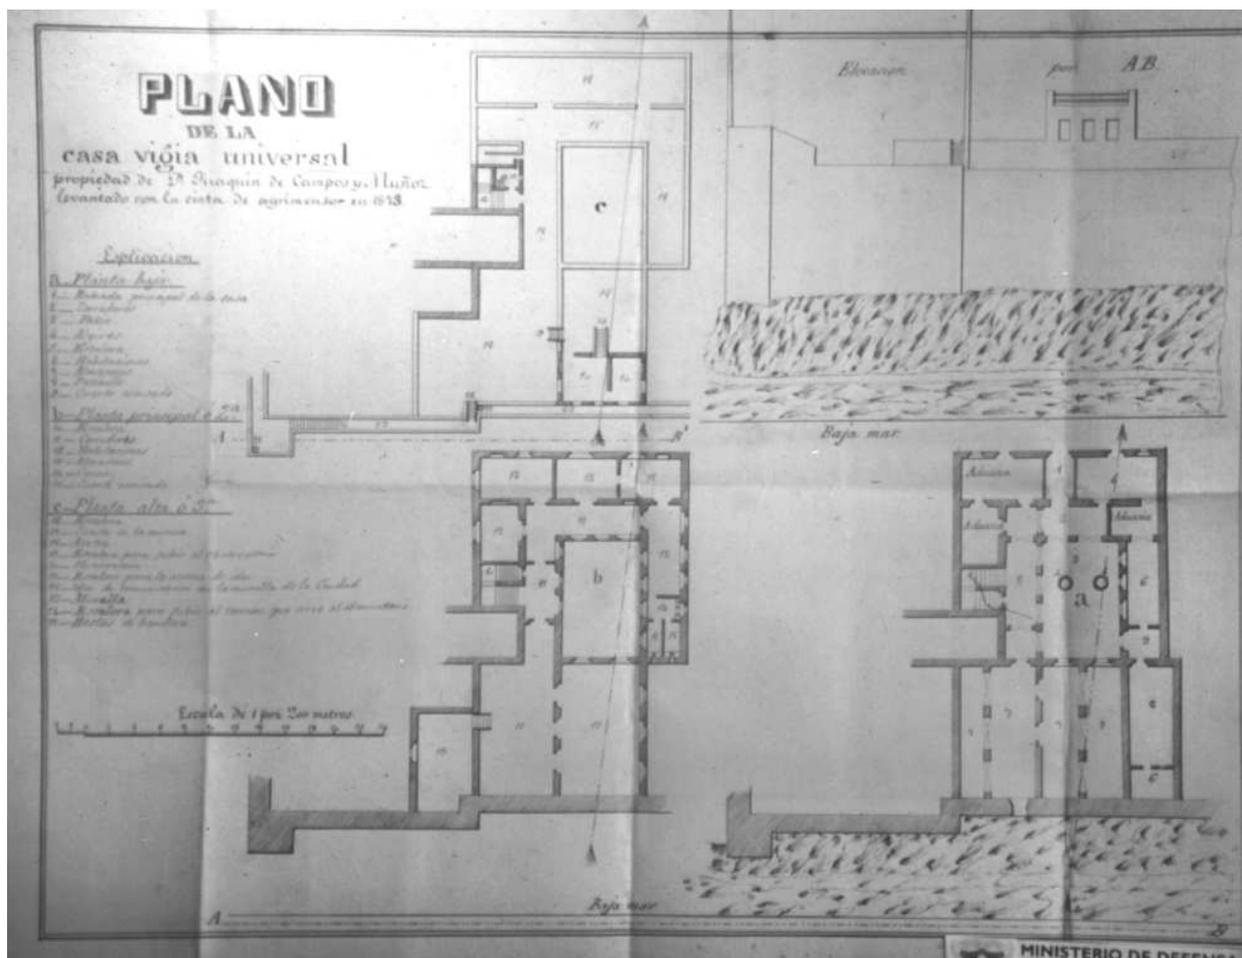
Plano de la Casa Vigía Universal, año 1873.
